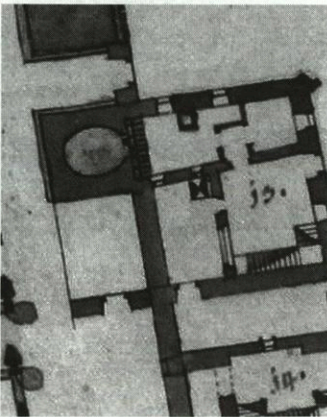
Obermünsterplatz 8, Grundriss vor 1766 (Münchener Plan).
